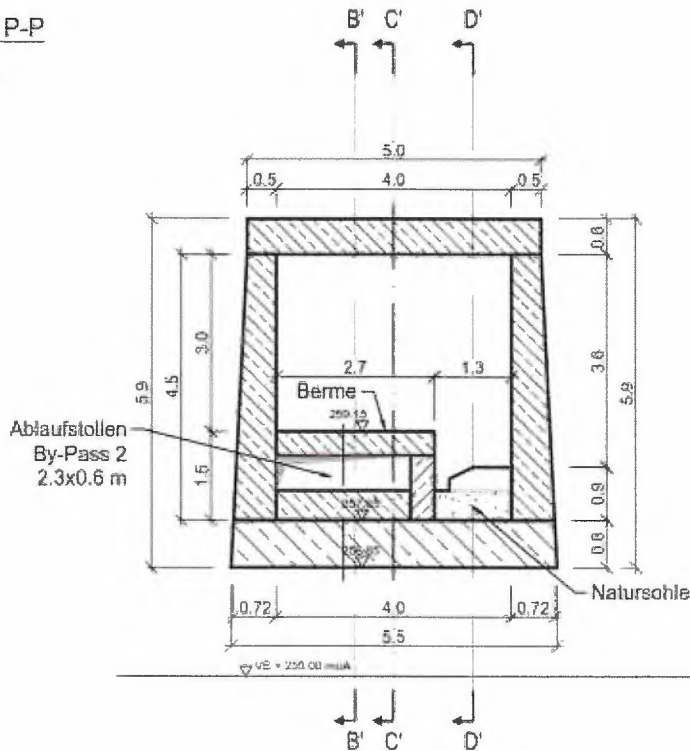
Schnitt Grundablass (Beispiel Stollen 2); aus Plan 12.5.2 (April 2021)
